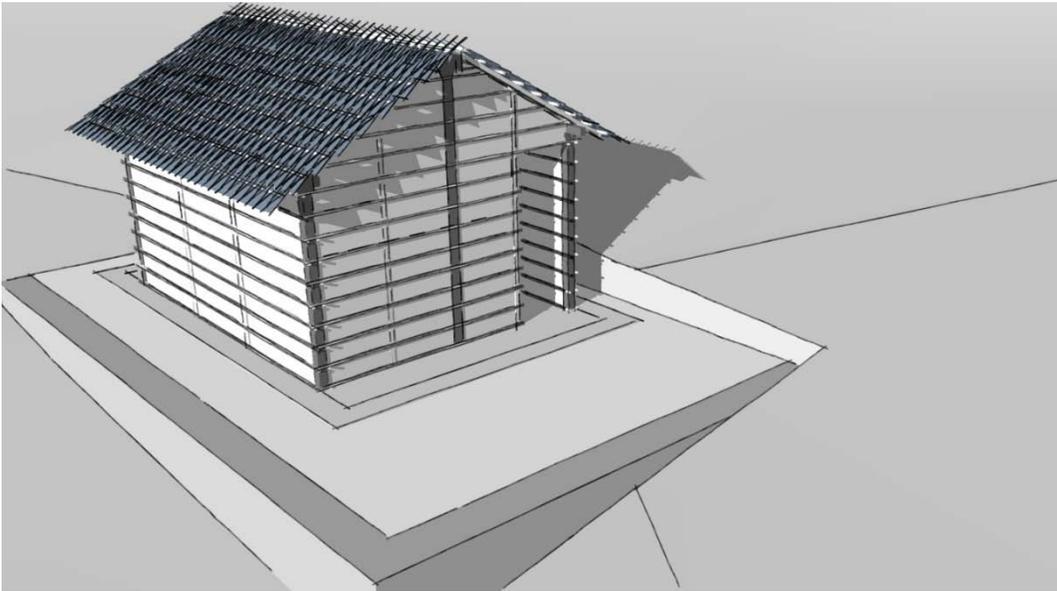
Relleno o enjarre de las paredes (partida "Sobreestructura").
